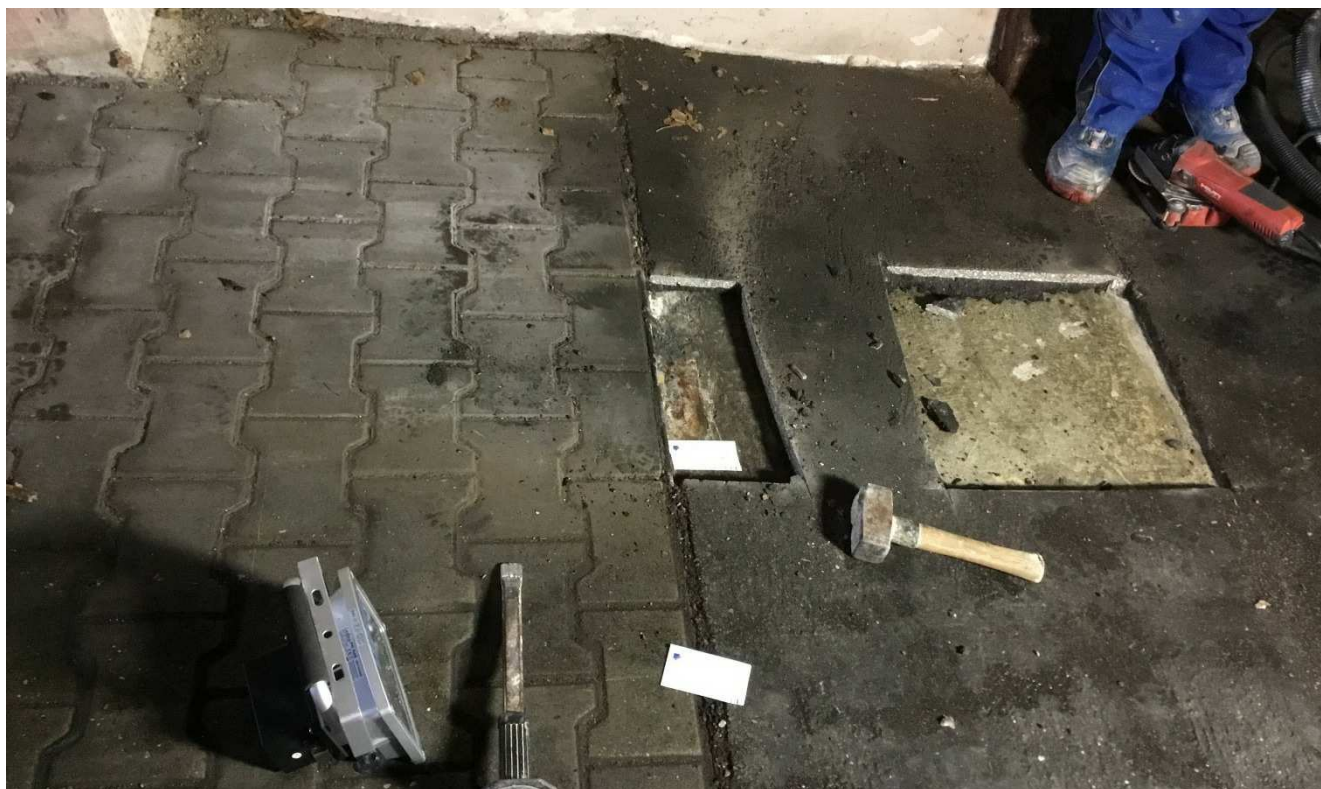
Übergang Rampenfuß/Tiefgarage: Der Gussasphalt schließt bündig an den Pflasterbelag der Rampe an. Wassereinträge aus der Rampe können ungehindert den Gefälleestrich unterlaufen (vgl. Abb. 11).
